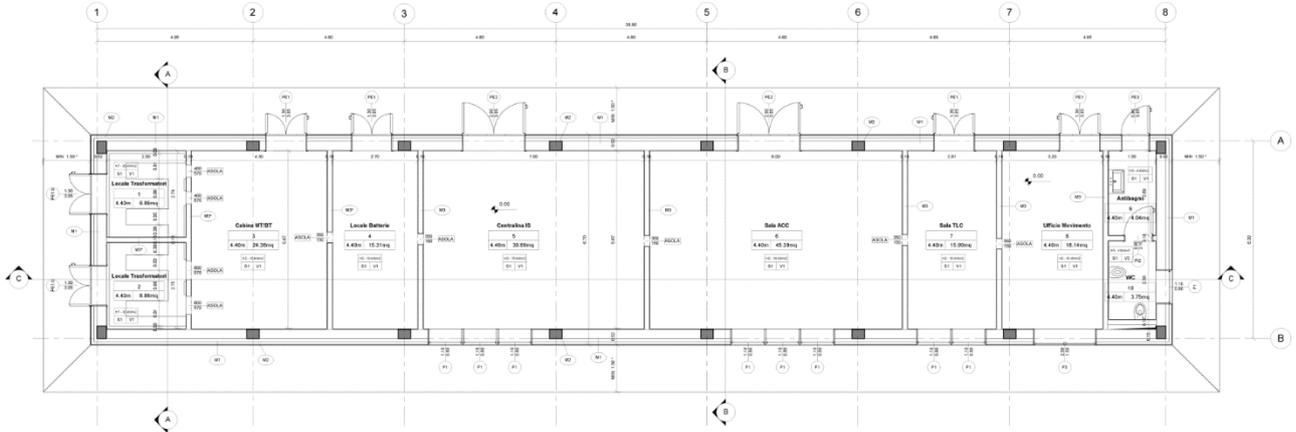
GA Sud Esterno – Pianta Architettonica Piano terra
